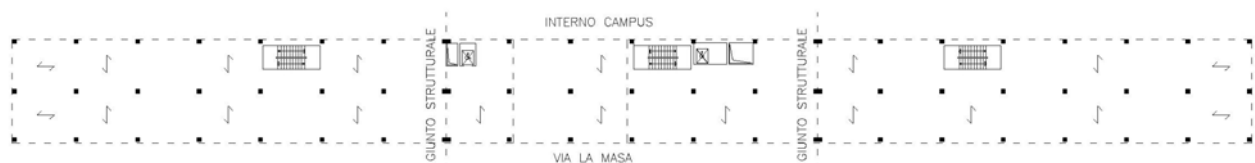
Schema strutturale dell'edificio n.22 con indicazione di pilastri, blocchi scala e giunti strutturali
